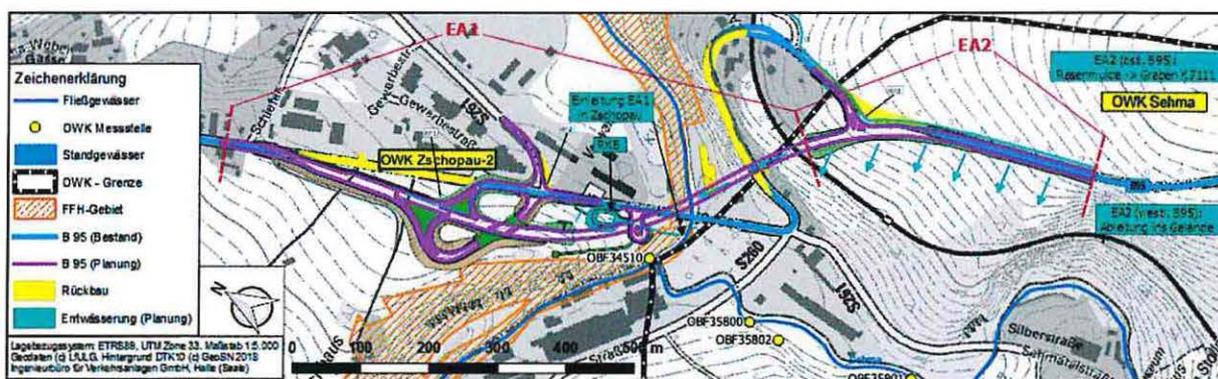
B95 (geplant), mit Entwässerungsabschnitten in ihrer Lage zu den OWK (techn. Planung EIBS Dresden)
